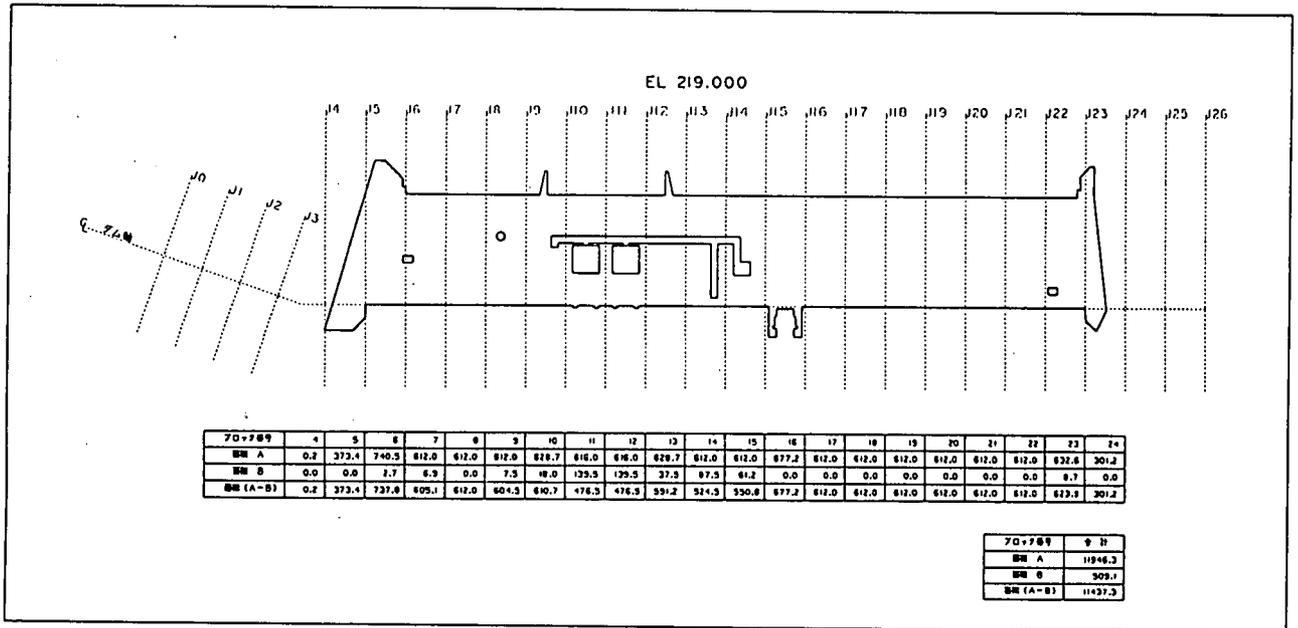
ダム堤体水平断面図及びコンクリート打設ブロック毎の区画面積
